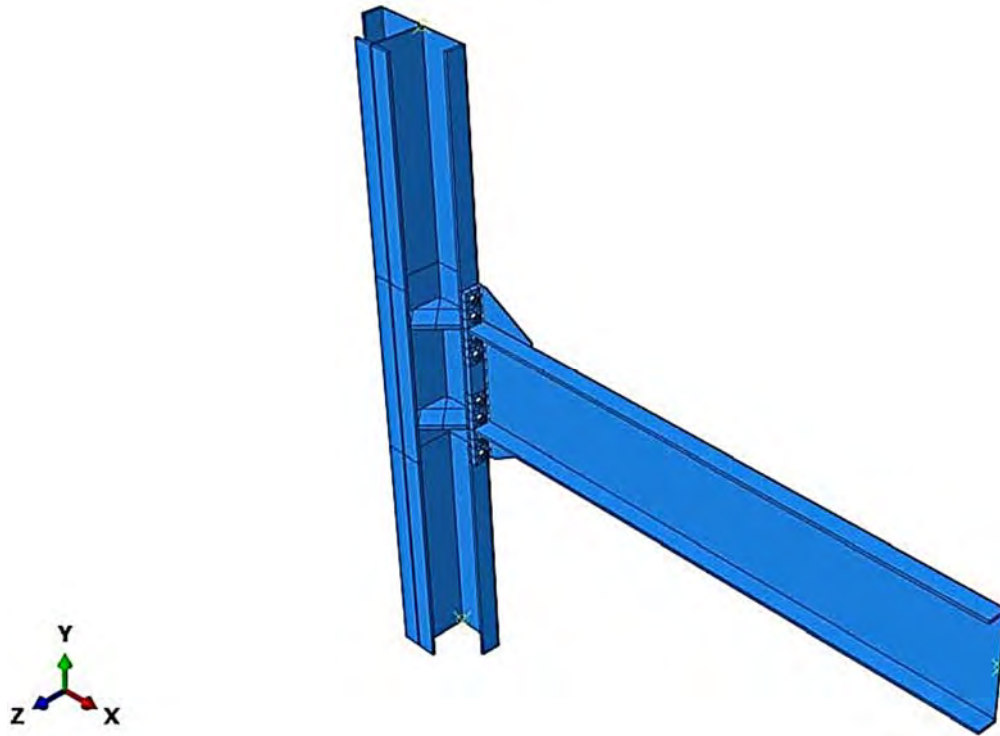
Ensamble de conexión placa extremo atornillada para columna cruciforme.
